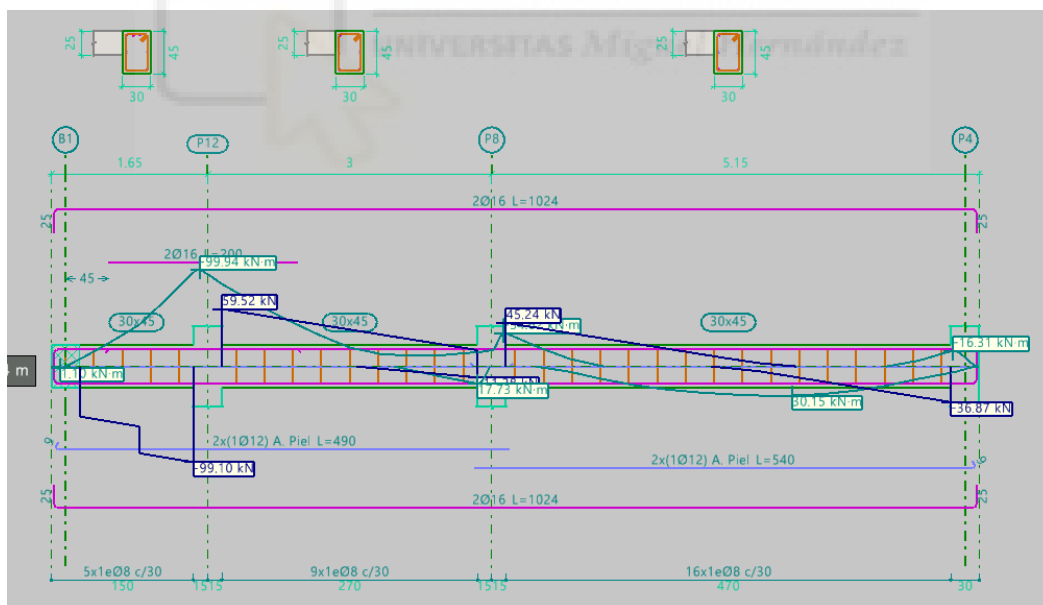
Viga T2 R2 N2 con viguetas de forjado empotradas en T2
